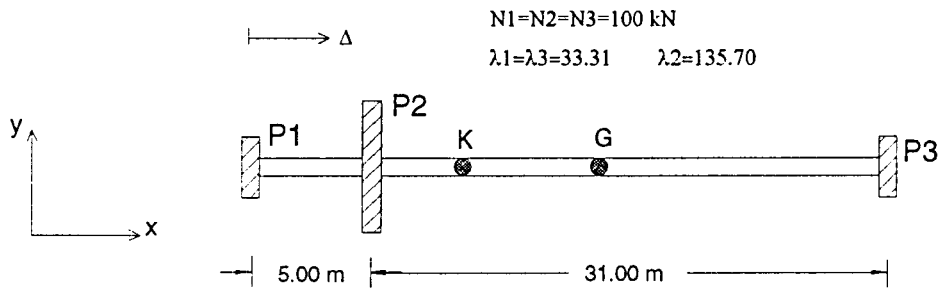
Exemplo de aplicação - Pórtico com um piso e três pilares.
